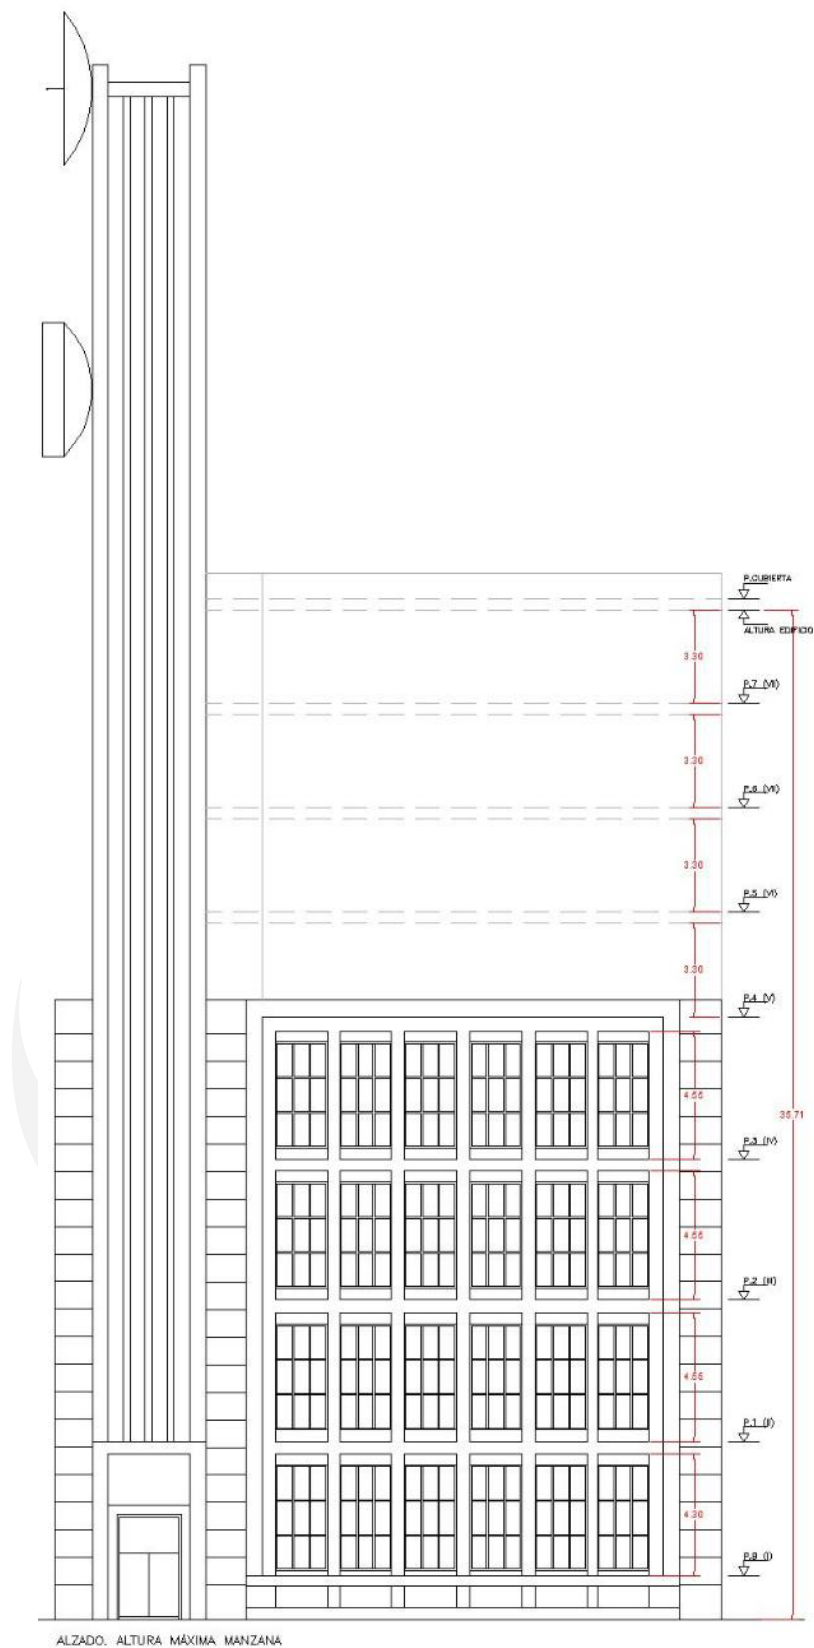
Alzado de edificación según altura de manzana (8 alturas)
